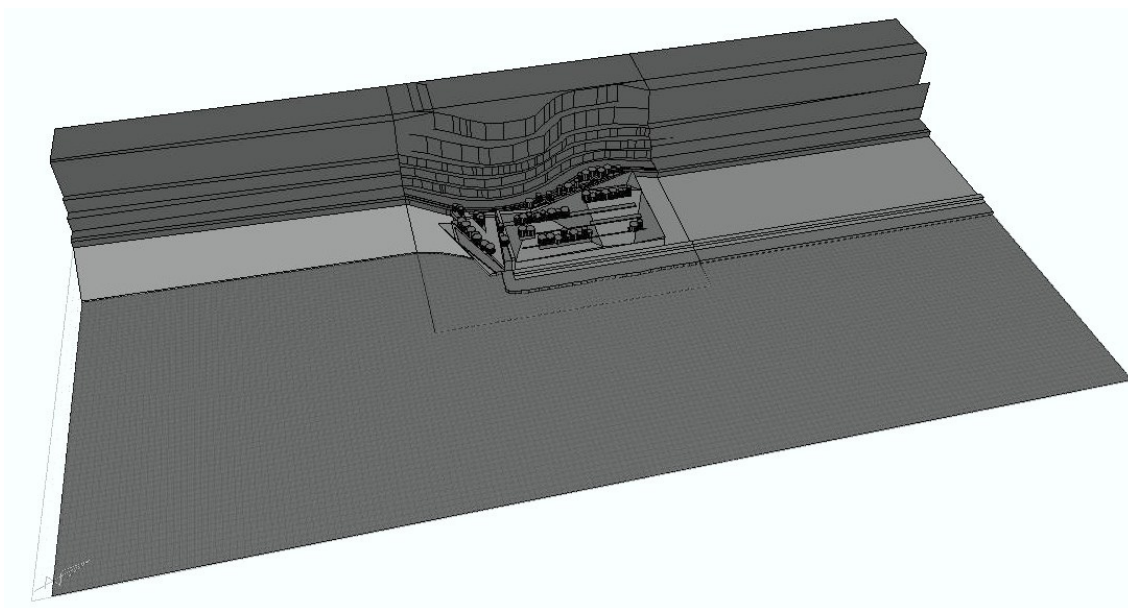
planimetria generale, modellazione tridimensionale tramite il software Ecotect
